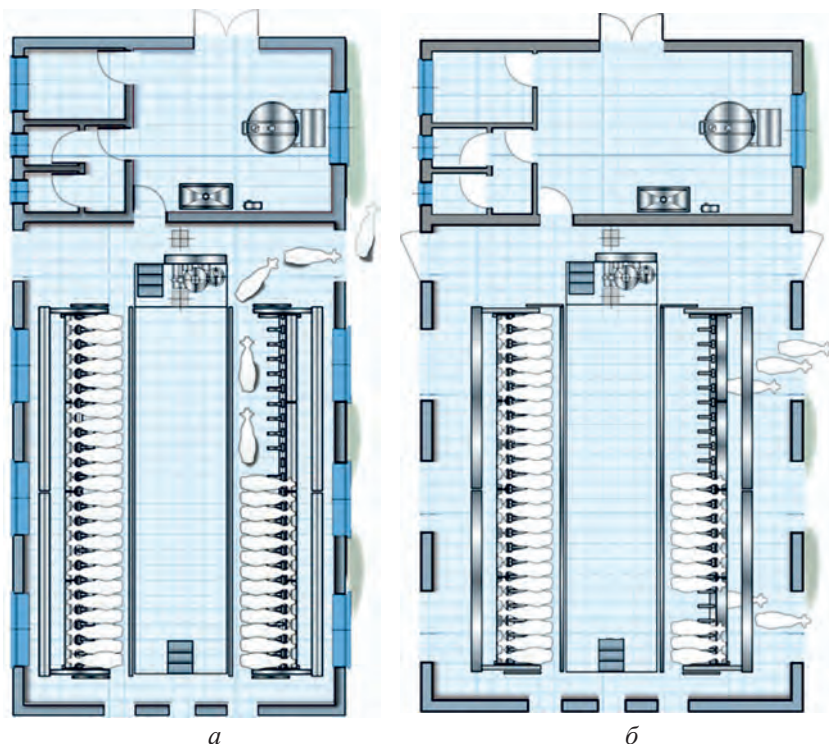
Схема доильного зала: а – с боковым выходом; б – фронтальным
